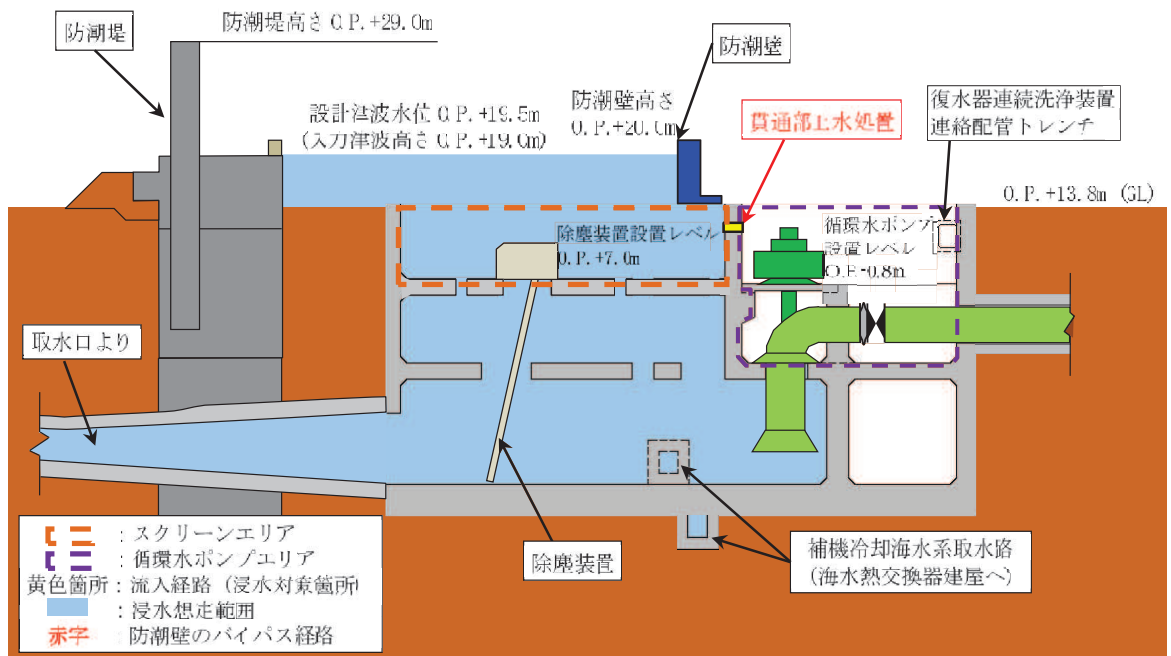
(2) 第 3 号機 海水ポンプ室 流入対策配置図 (A-A 断面図)
